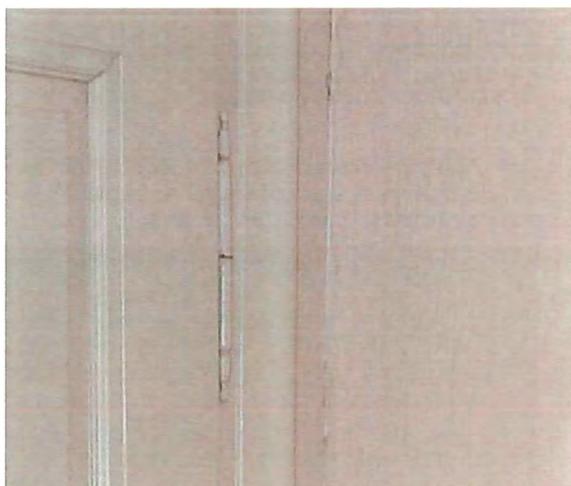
Erdgeschoss, Raum 0.14, Rückseite der Zimmertür mit Tropfenfischband.
